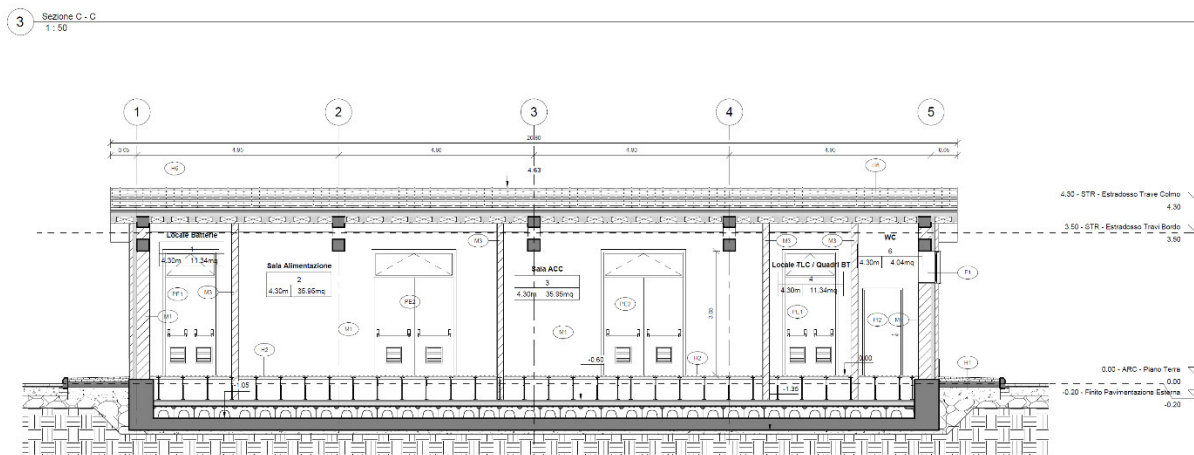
Sezione C-C – Layout Fabbricato FA01
